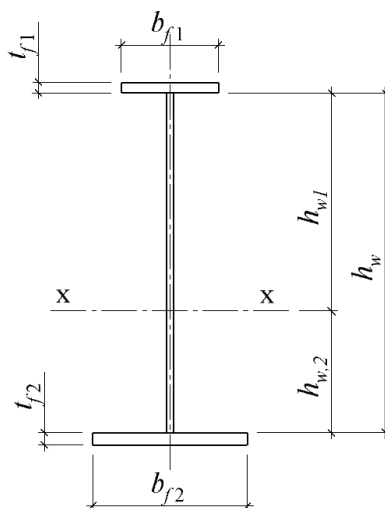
Поперечное сечение сварной балки с одной осью симметрии при более развитом нижнем (растянутом) поясе
